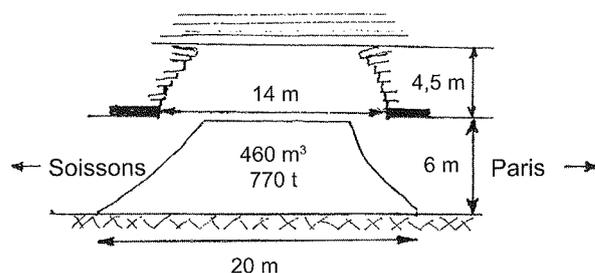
Profil en long de l'effondrement du tunnel de Vierzy.
